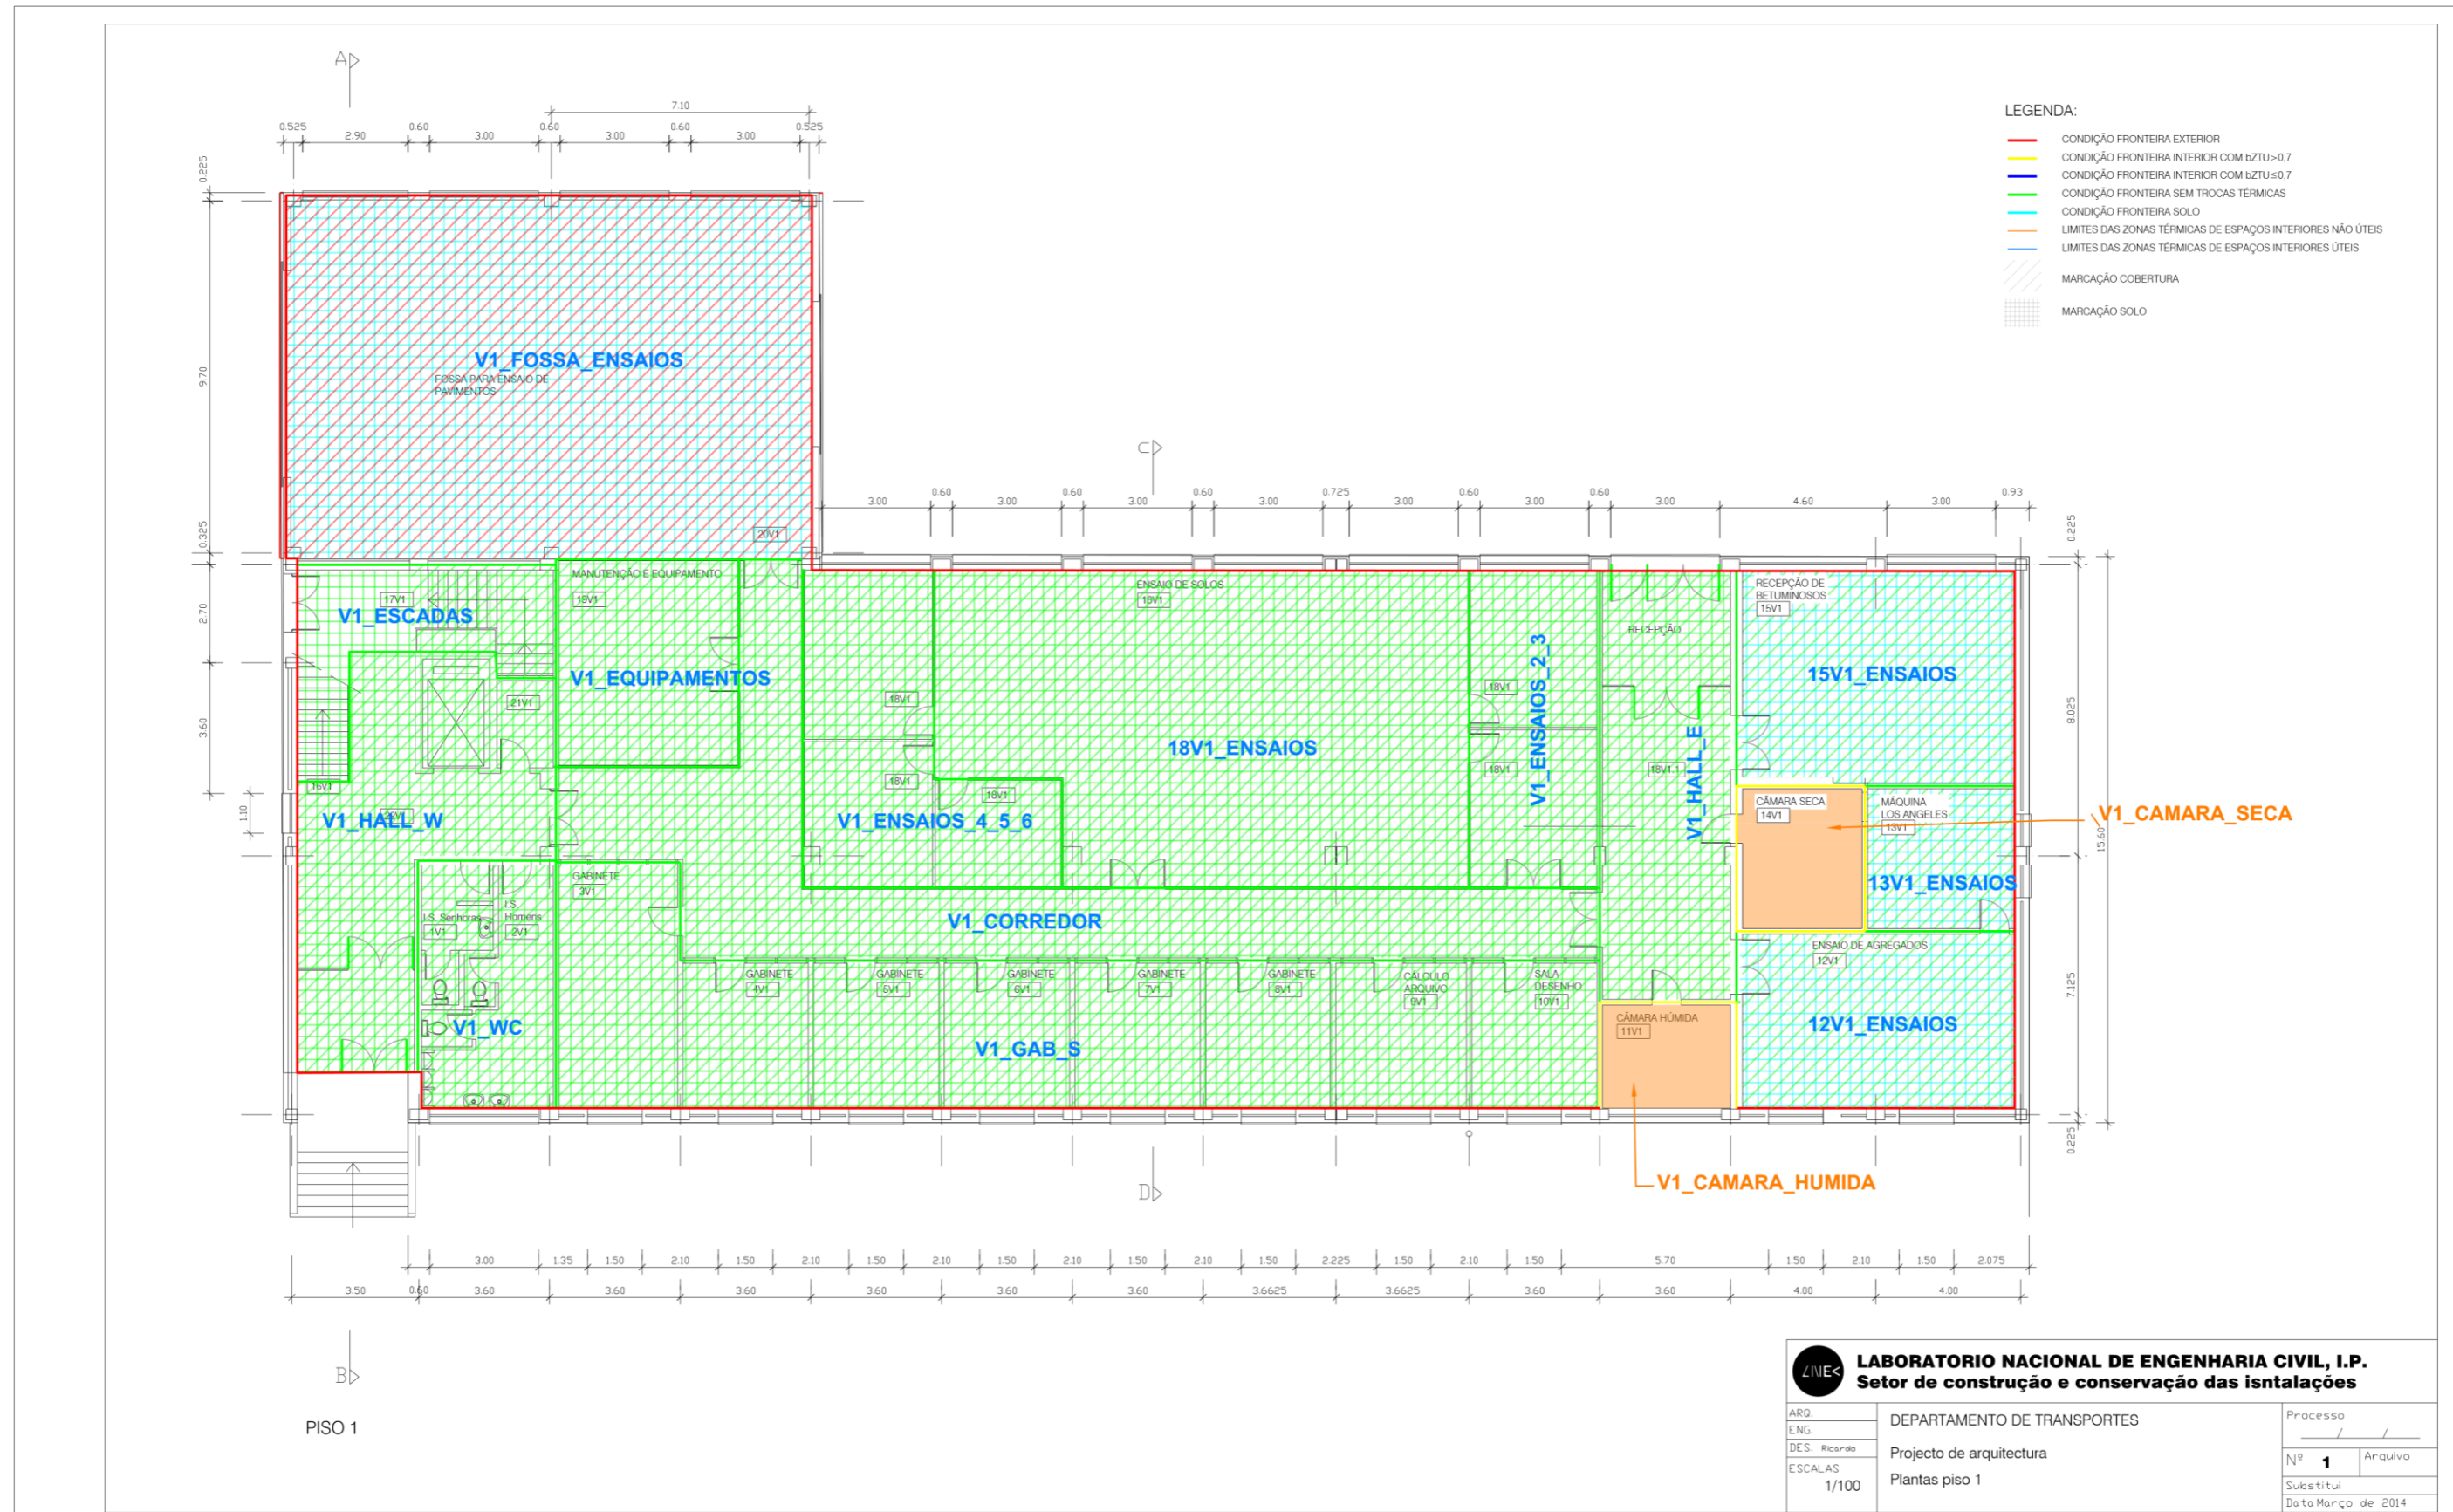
Figura – Planta do 1º Piso: Identificação das zonas térmicas
